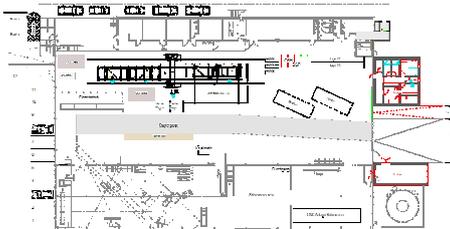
Grundriss nach Umstrukturierung
